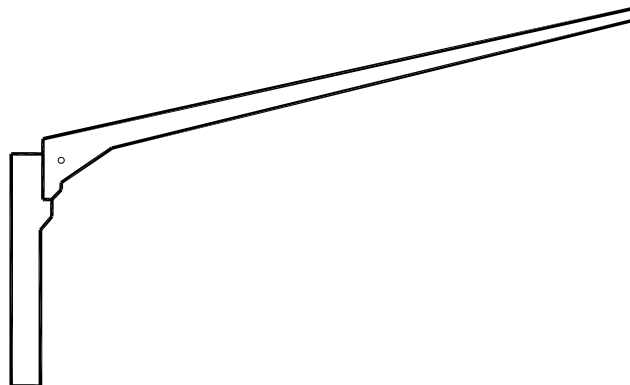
Конструкція вузла з'єднання ригеля зі стійкою
